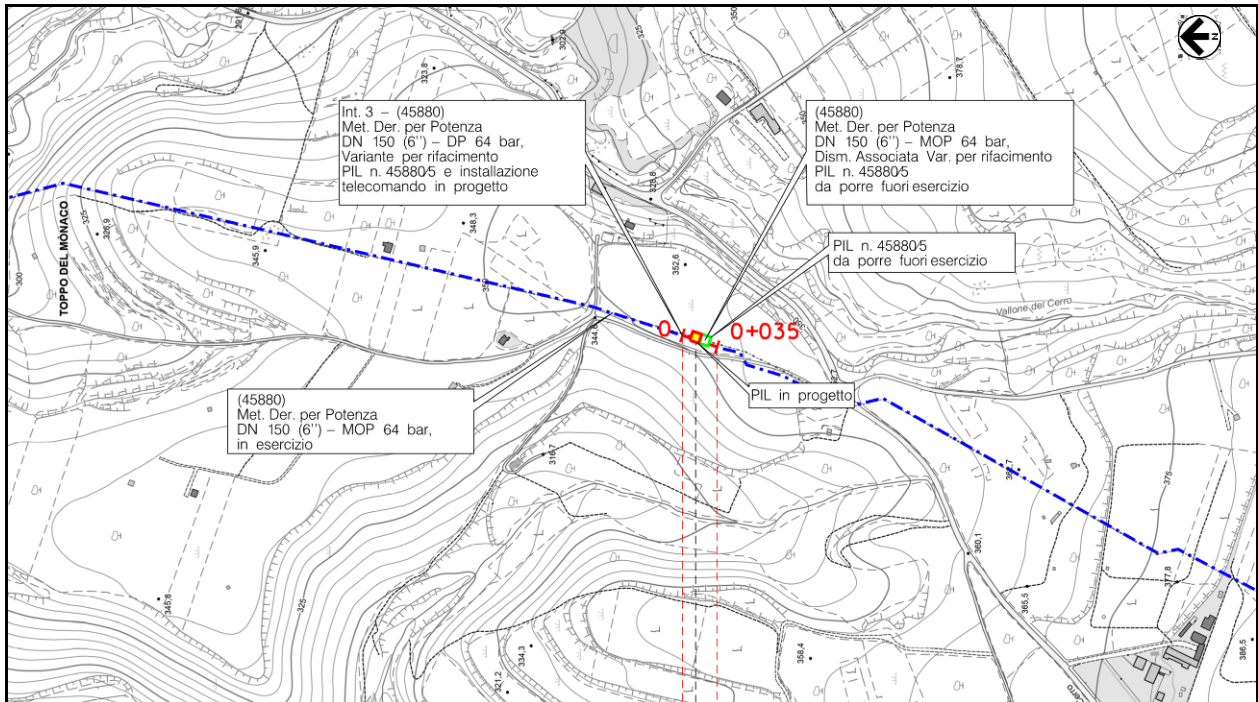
/C.b – Planimetria 1:5.000 con localizzazione dell'area dell'Intervento n.3 (progetto in rosso, dismissione in verde, esistente in blu)
